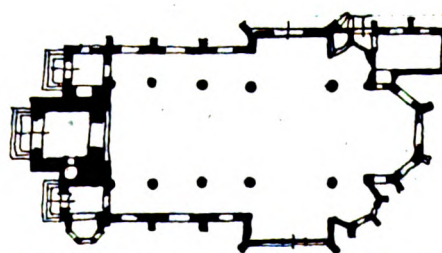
Grundriss zur Pfarrkirche in Castellaun.
